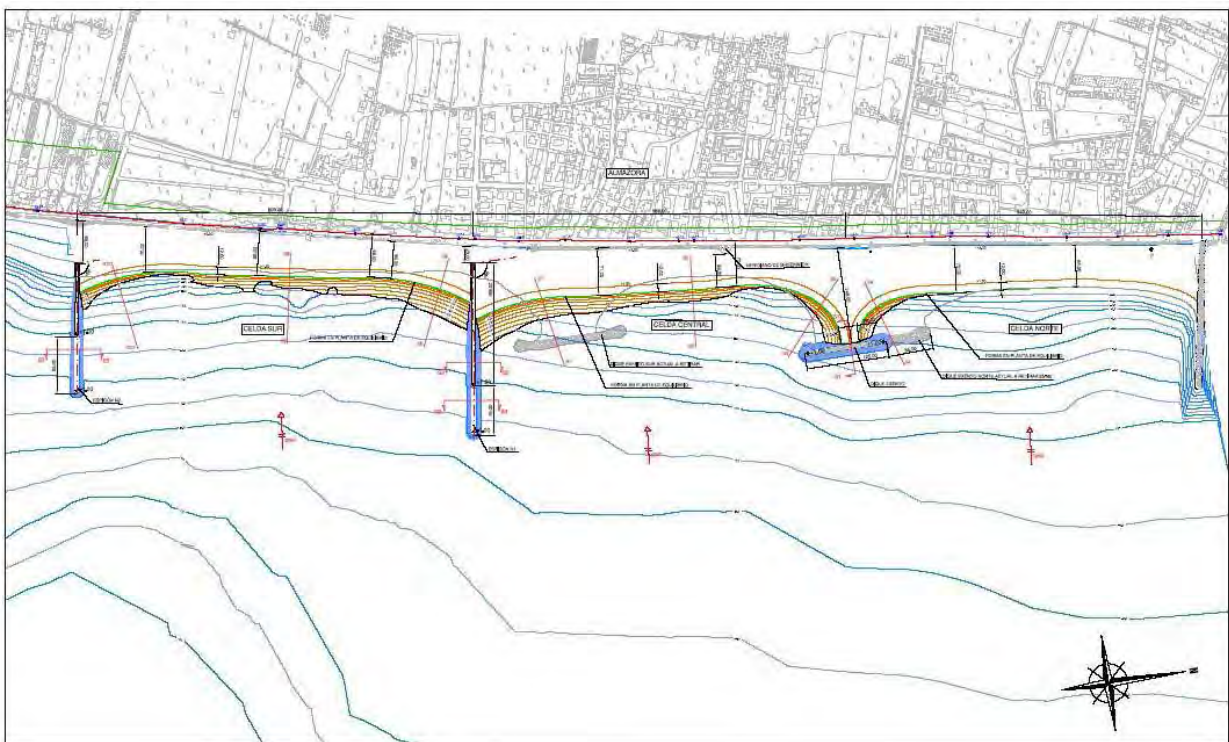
Configuración en planta de la actuación (Fuente: IBERPORT CONSULTING 2010)
